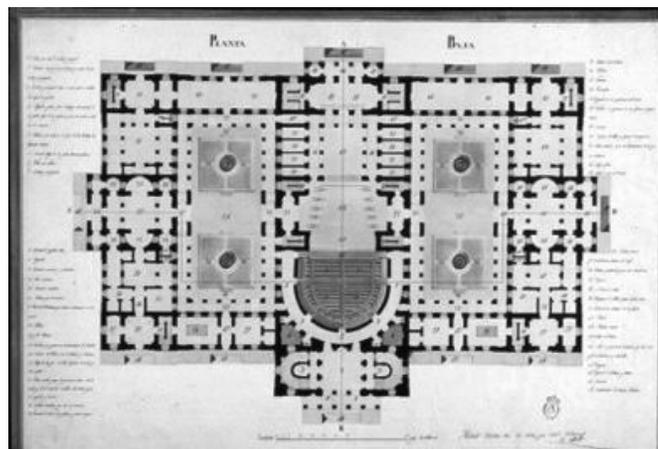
Cirilo Salinas. Planta baja de teatro público para capital, 1832.
